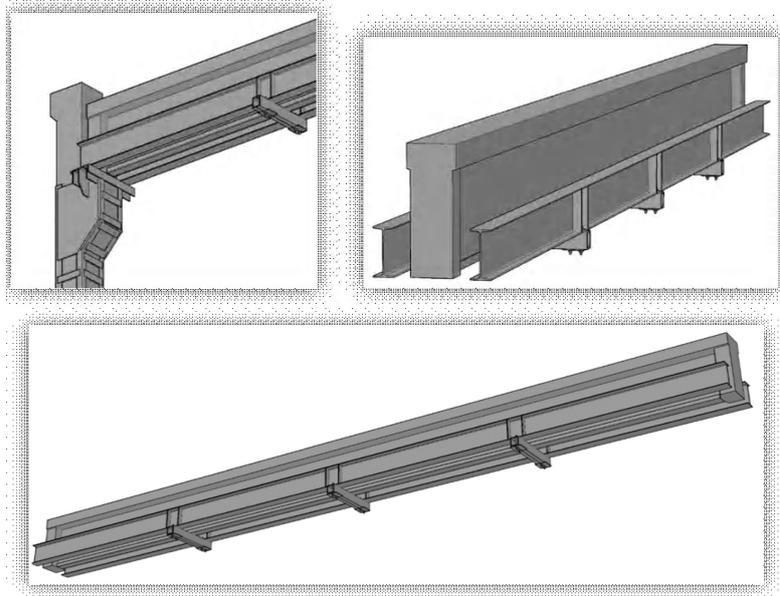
Усиление железобетонной балки подведением металлических разгружающих двутавров.
